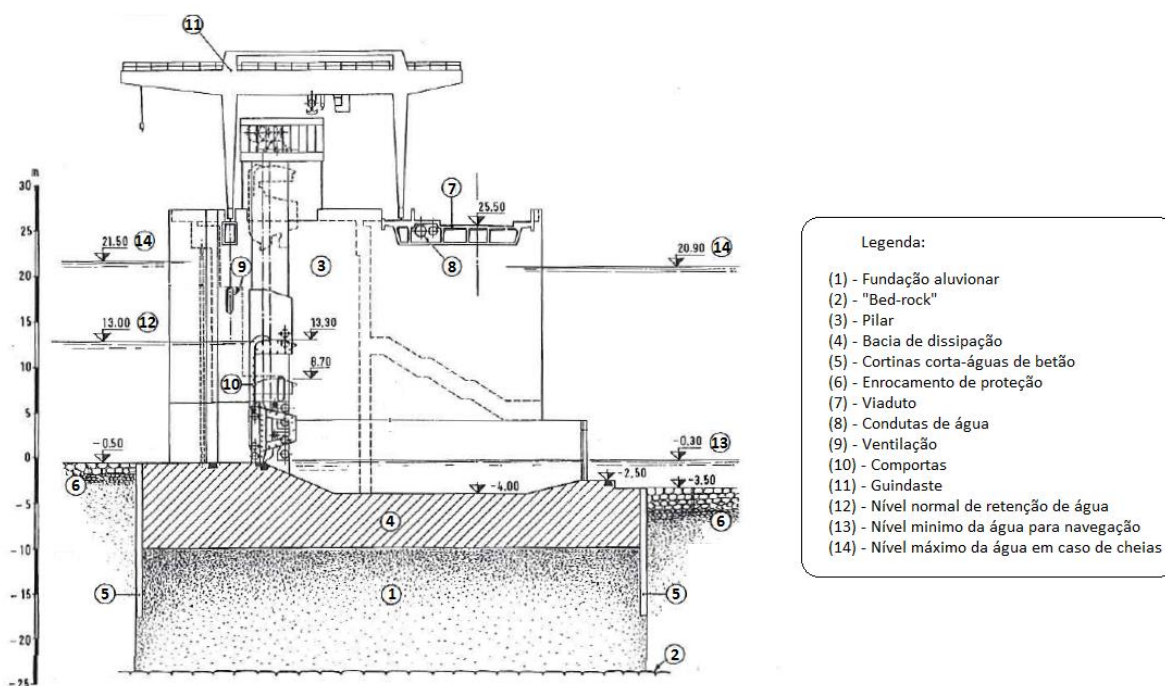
Corte tipo da barragem de Crestuma-Lever [3]
